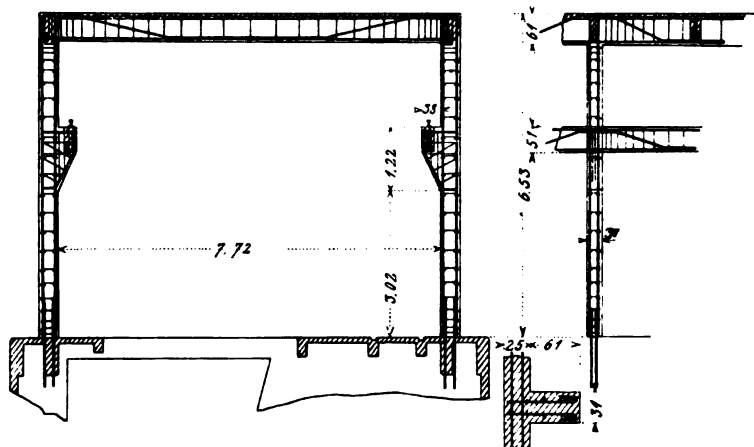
Rechenanlage der Ontario Power Co. an den Niagara-fällen, Längs- und Querschnitt des Oberbaues.
